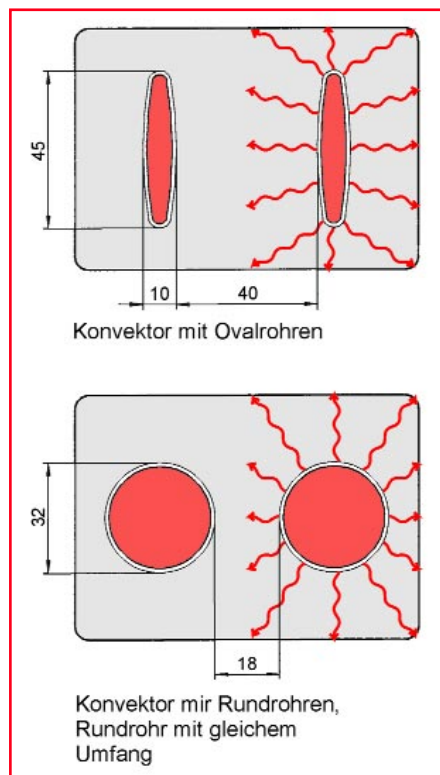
Ausführungsvergleich Konvektor mit Ovalrohren und Rundrohren, mit gleichem Umfang (Kontaktfläche Rohr-Lamelle)
